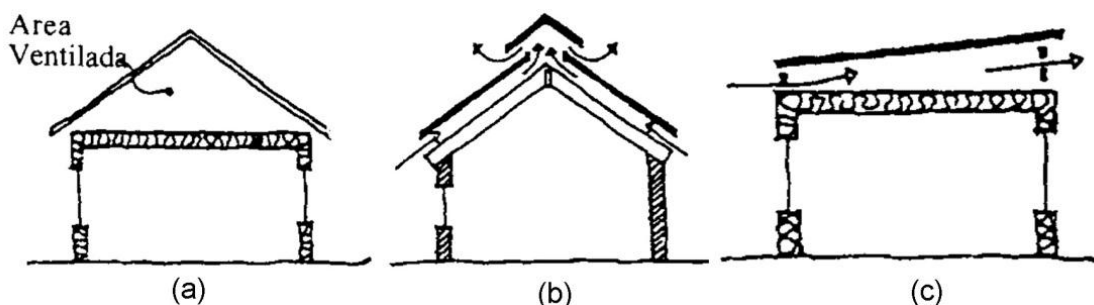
Ejemplos de cubiertas ventiladas. Ático ventilado (a), cubierta inclinada con ventilación sofito-cumbrera (b) y techo plano con cubierta secundaria y ventilación cruzada (c). Fuente: Stulz & Mukerji, 1993.
